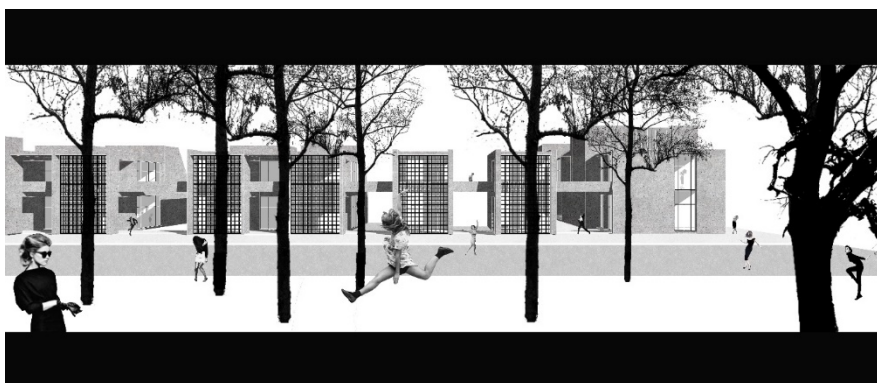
Ilustración del proyecto, fachada este. Caraguay (2020)
